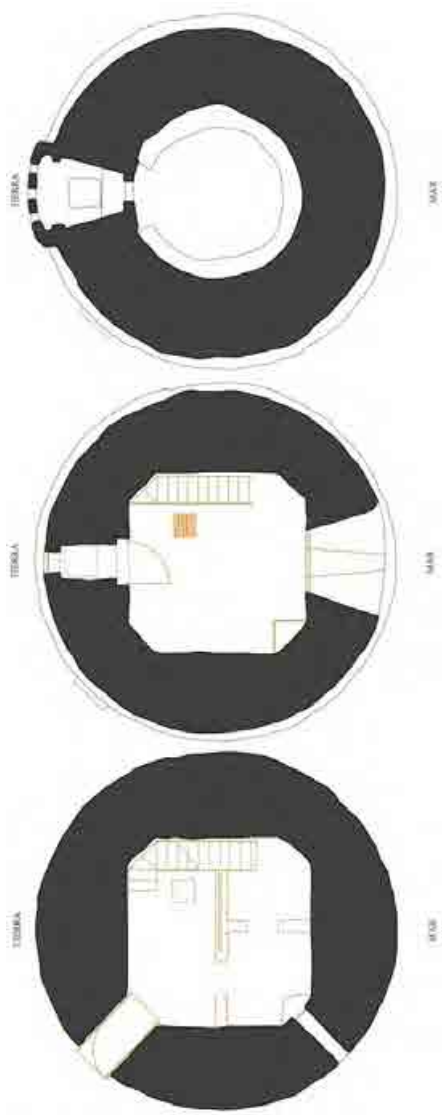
Torre de Cala Teulera. Terraza, planta primera y planta baja (Mónica Fernández).
